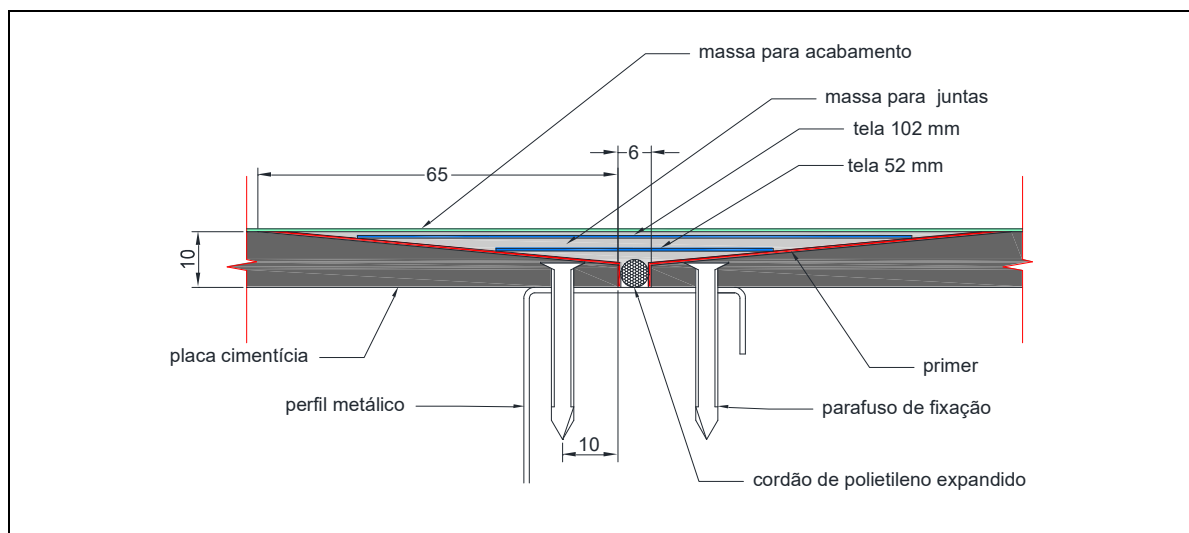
Esquema em corte transversal do tratamento das juntas entre placas cimentícias – face externa da parede
